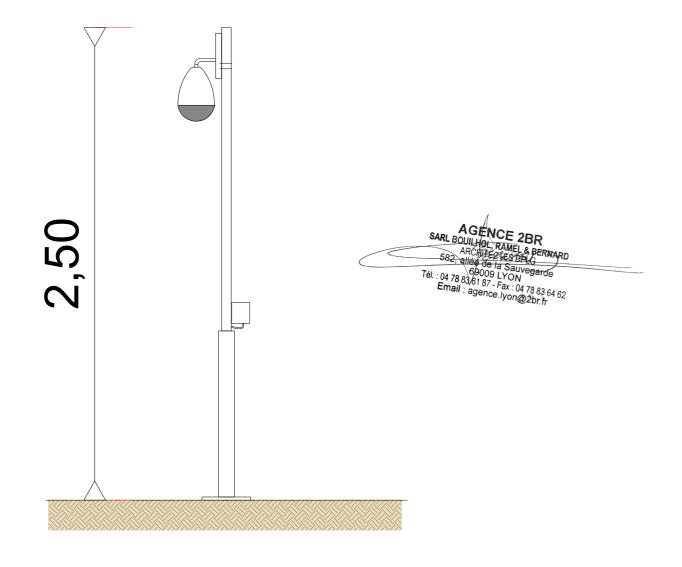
DETAILS - ÉLÉVATIONS DE LA CAMÉRA - échelle 1/40e
